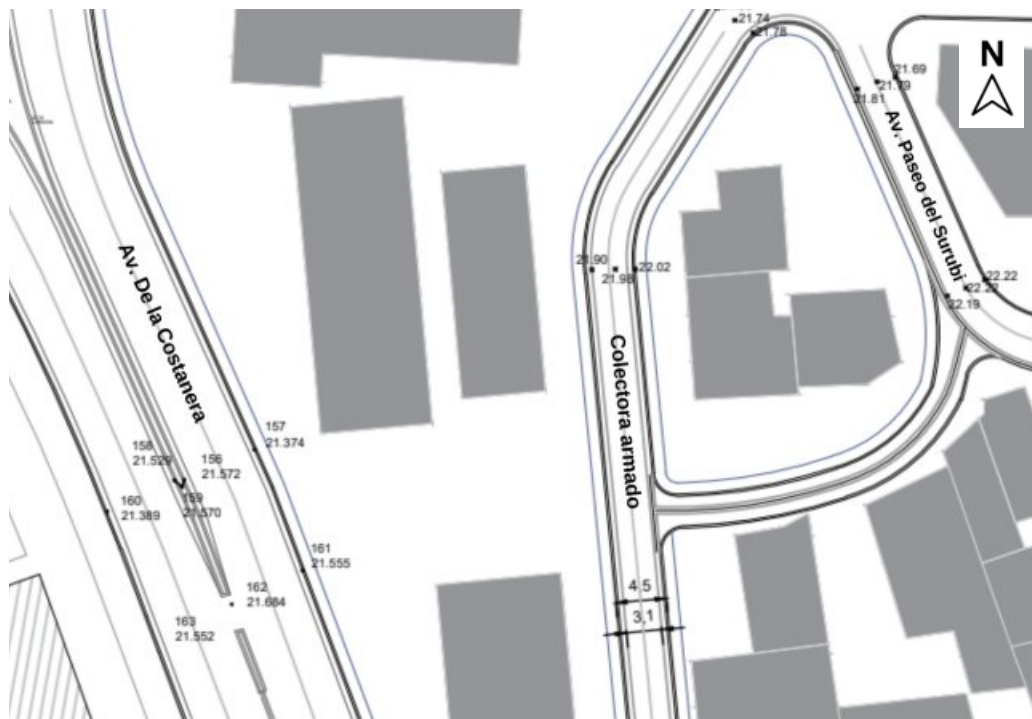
Porción del plano de proyecto de pavimento
